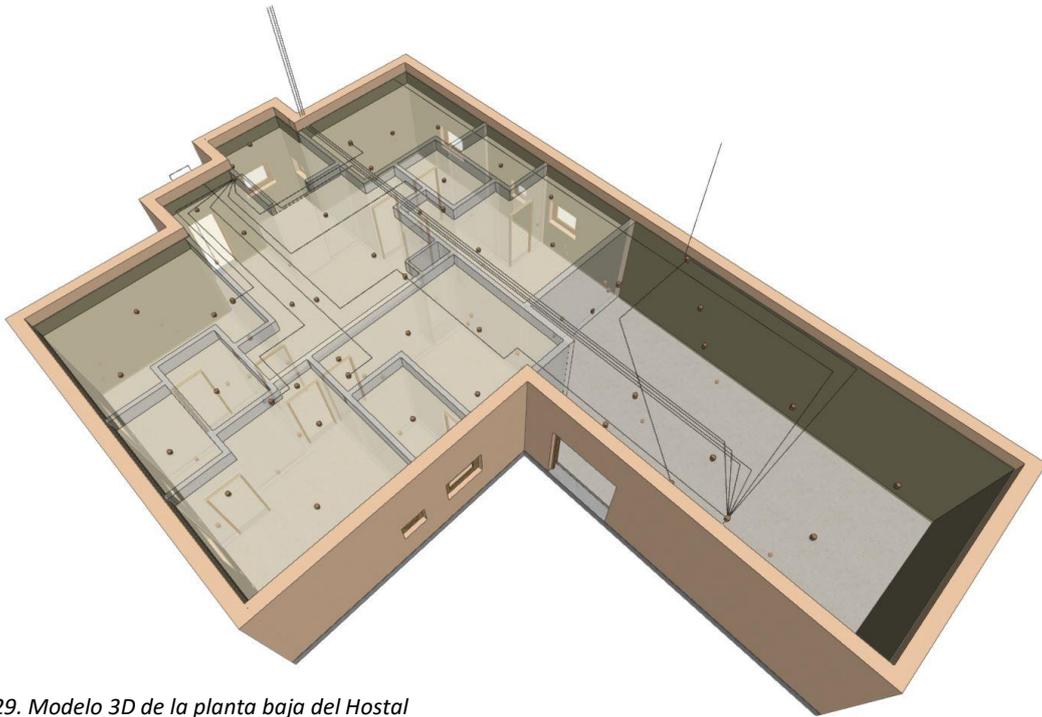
Modelo 3D de la planta baja del Hostal Rural Pina con la instalación eléctrica.
